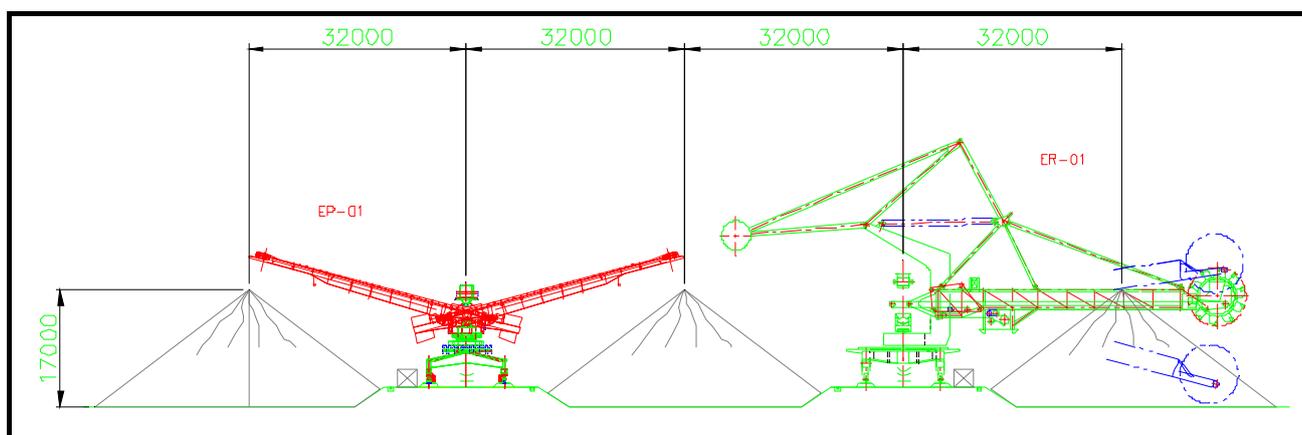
Seção típica do pátio: empilhadeira e empilhadeira/retomadora.
